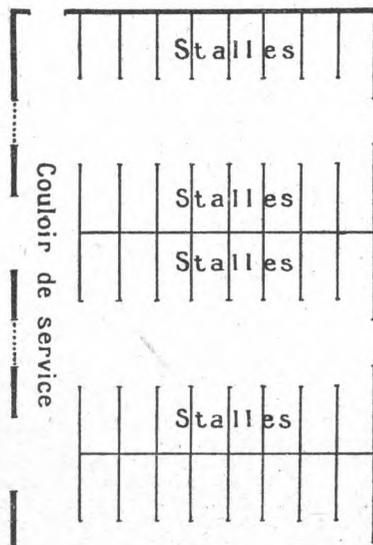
Plan schématique d'une étable transversale tête à tête.
